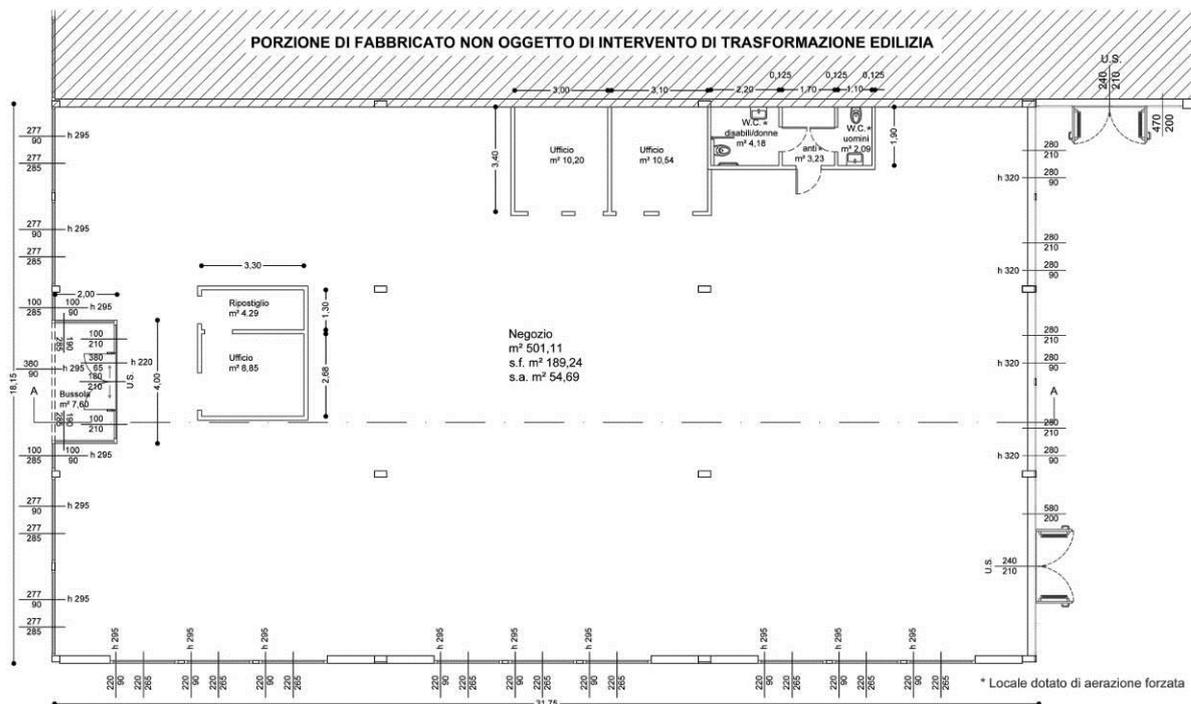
Pianta di progetto (Fonte: Progetto SCIA 04.05.2017).
